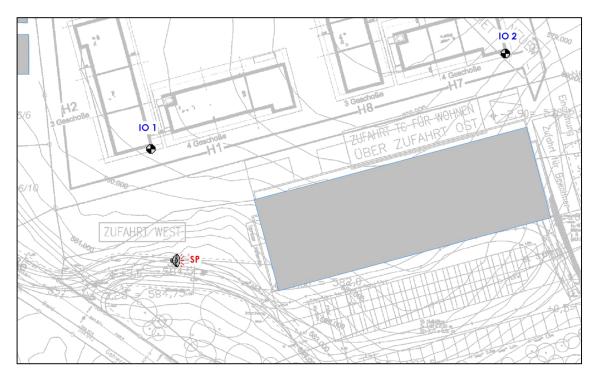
Lageplan mit Eintragung der Punktschallquelle SP (Spitzenpegel)
